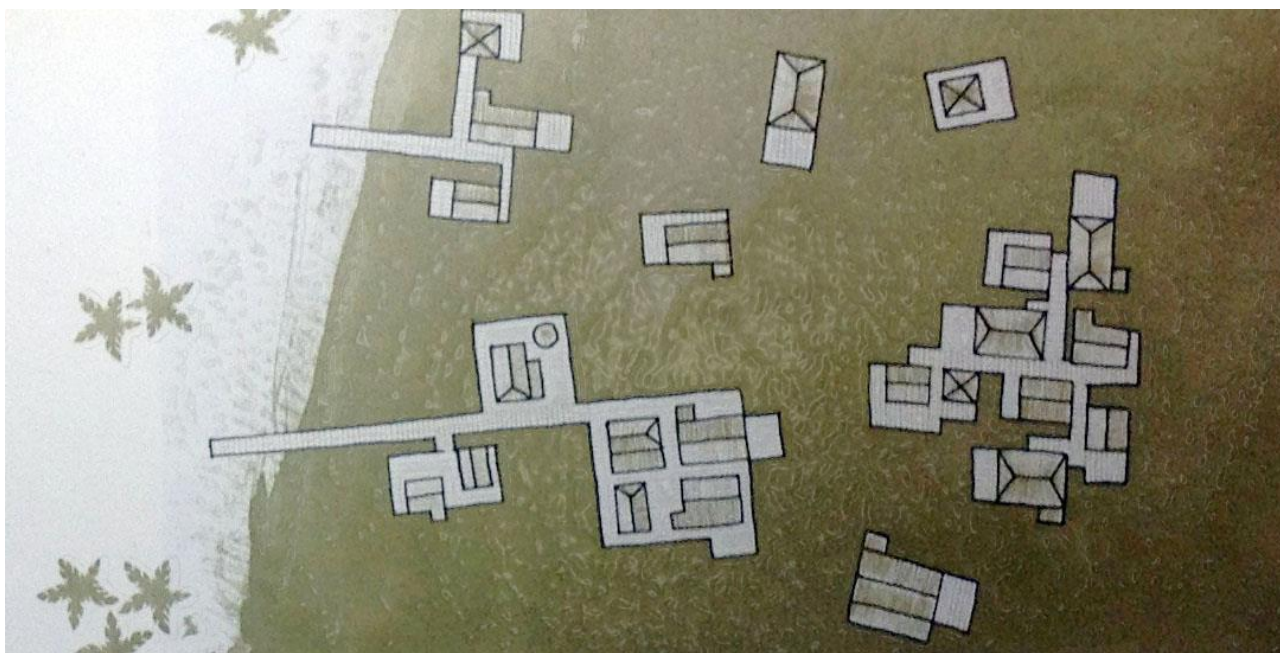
Planta esquemática dos aglomerados palafíticos (Brahamón & Álvarez. 2009)
